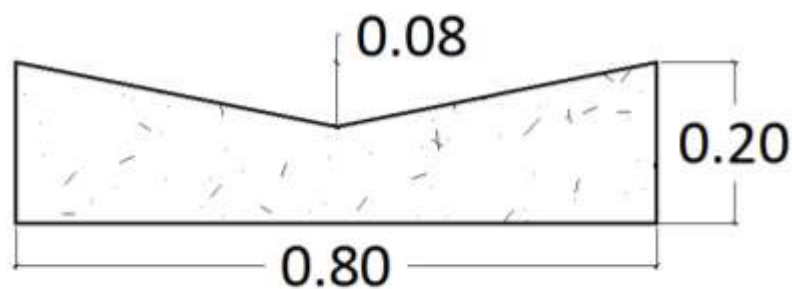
Sección Transversal de Cuneta – Badén
